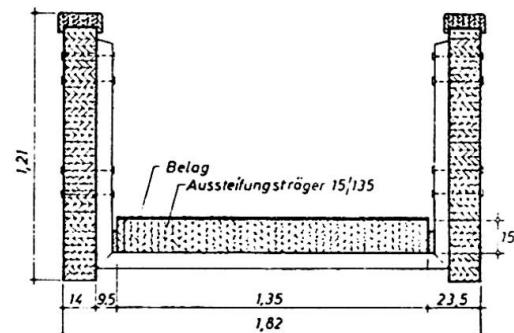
Brettschichtträger als Fahrbahn und als Horizontalaussteifung
